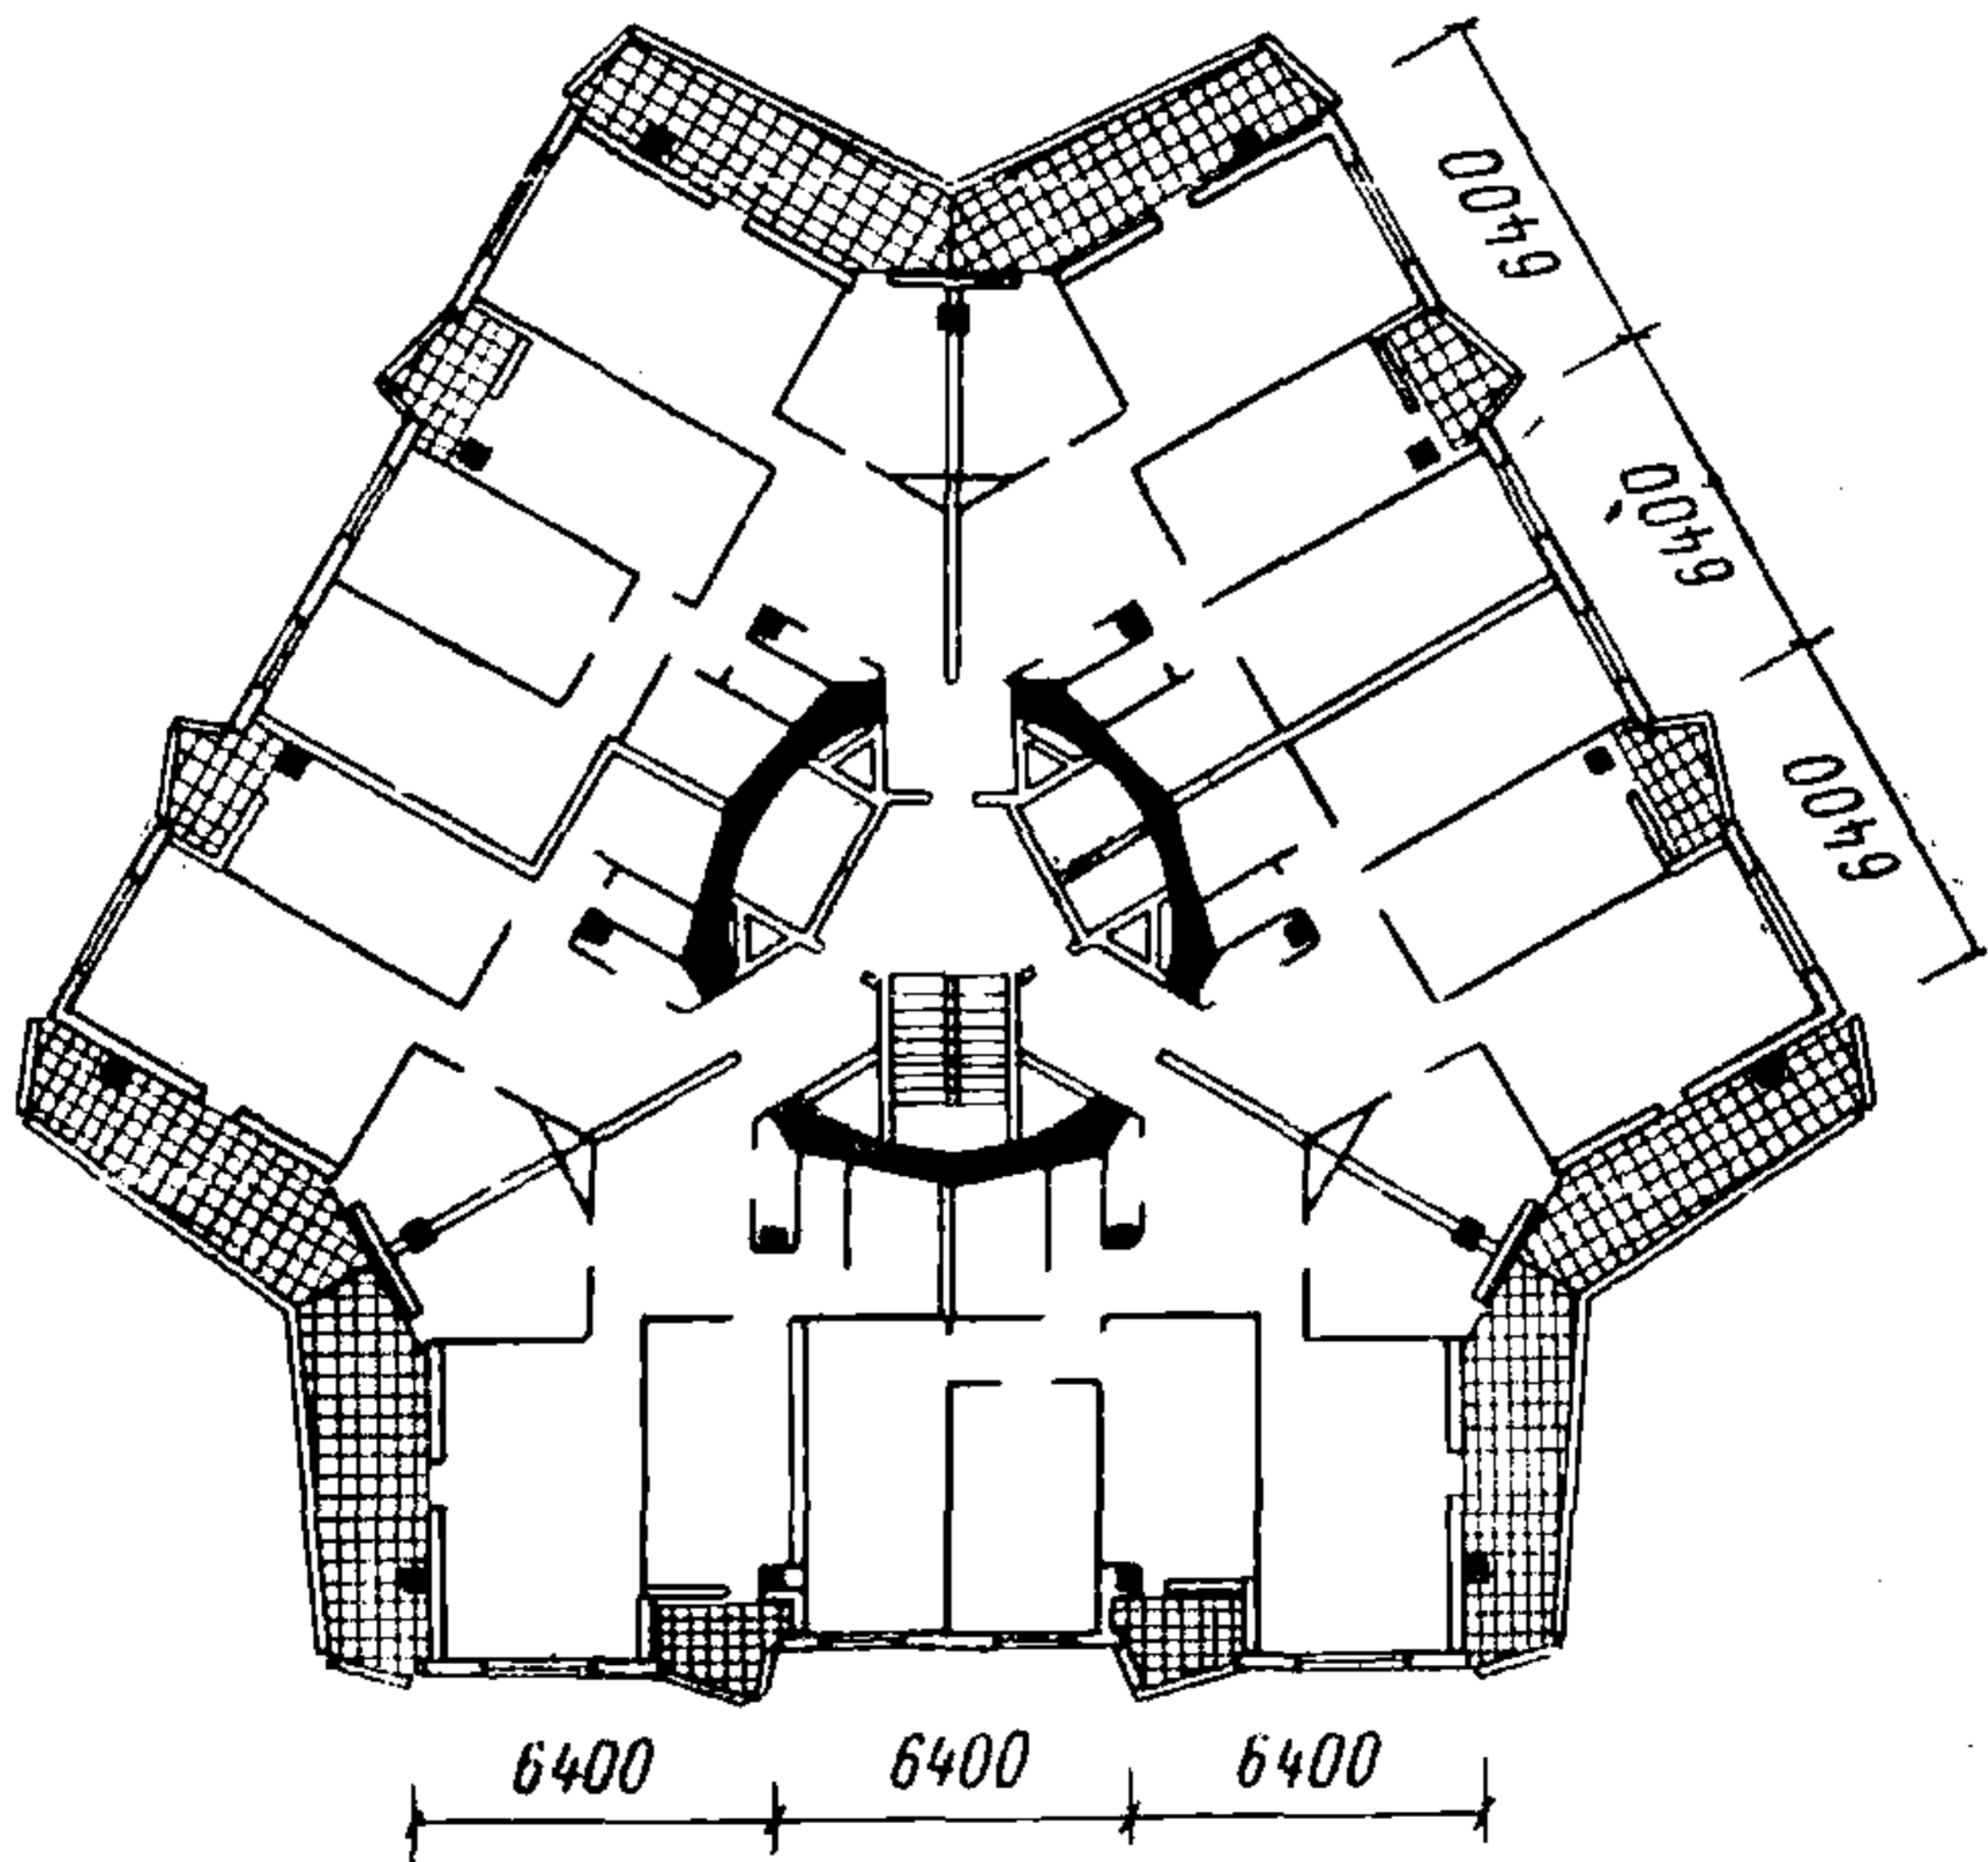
План типового этажа 16-этажного жилого дома типа «трилистник» (СПЭКБ АрмССР)
